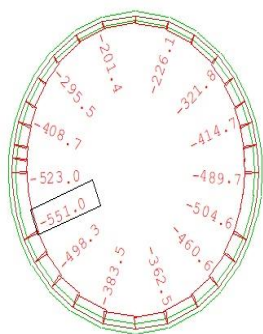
Эпюра продольных усилий, возникающая в конструкции железобетонной обделки на стадии завершения строительства тоннеля в разрезе.
